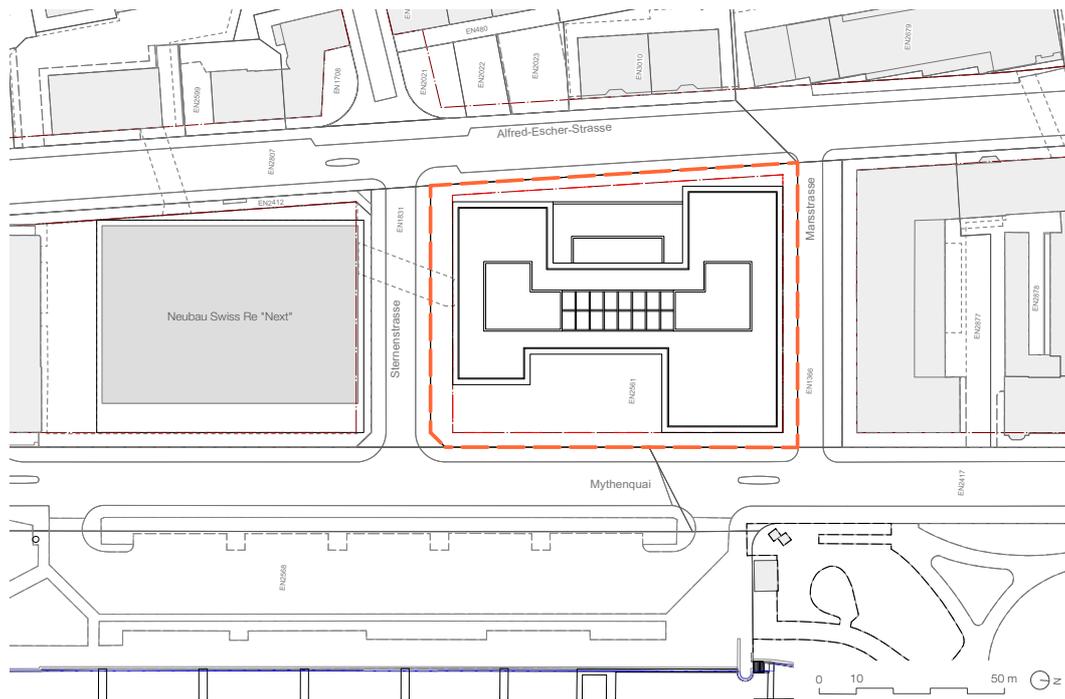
Projektperimeter Gestaltungsplan mit Richtprojekt (Dachaufsicht)
